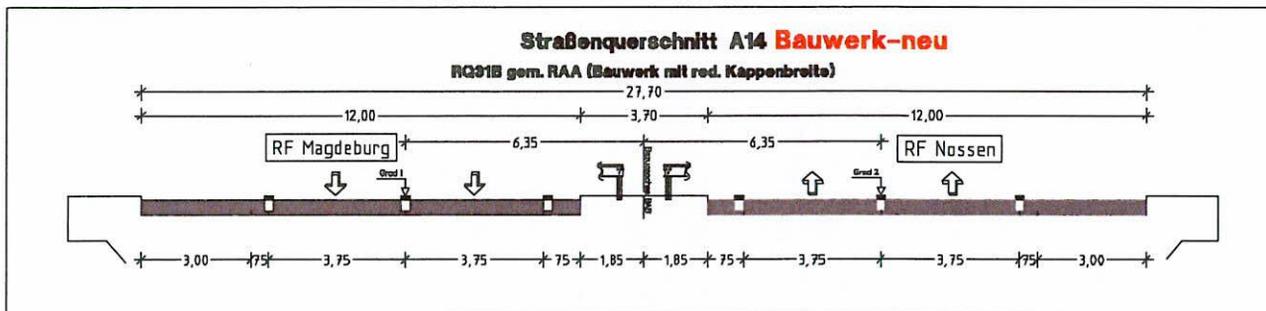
geplanter Bauwerksquerschnitt RQ 31B
